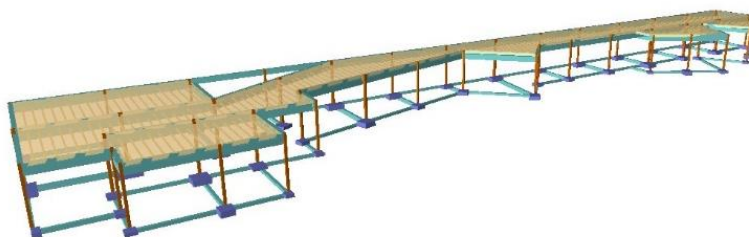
Modelado 3D de la estructura de hormigón en CYPECAD.
